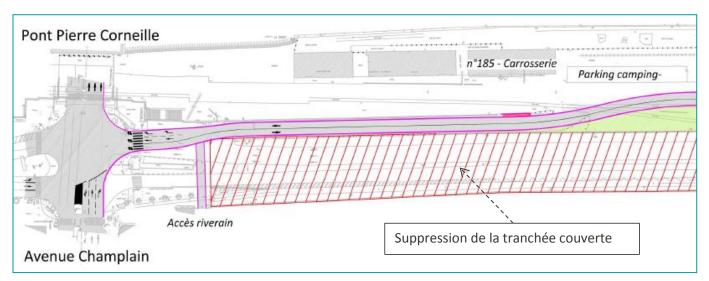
Plan du raccordement de la nouvelle voirie au droit du pont Corneille
